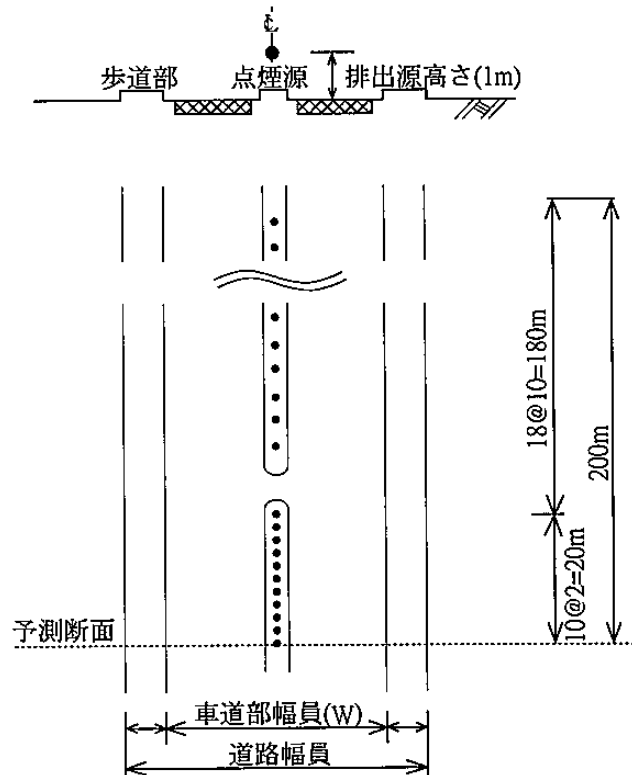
排出源の位置図 (断面及び平面図)
